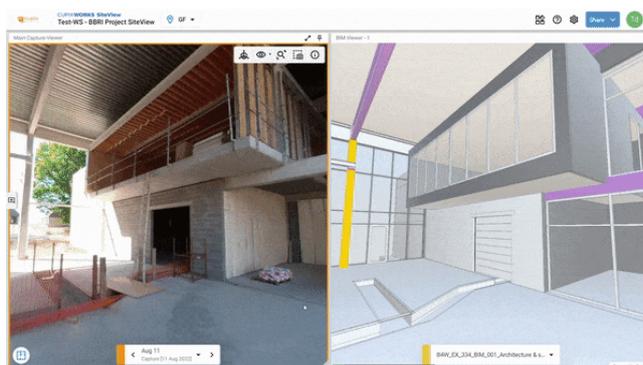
Suivi de chantier et états d'avancement facilités par le BIM
